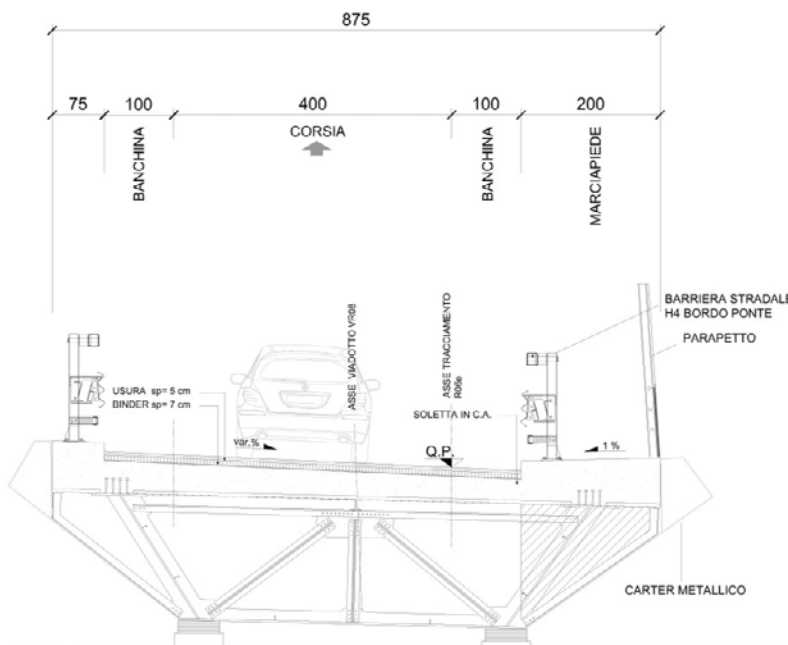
Sezione tipo rampa monodirezionale su viadotto
